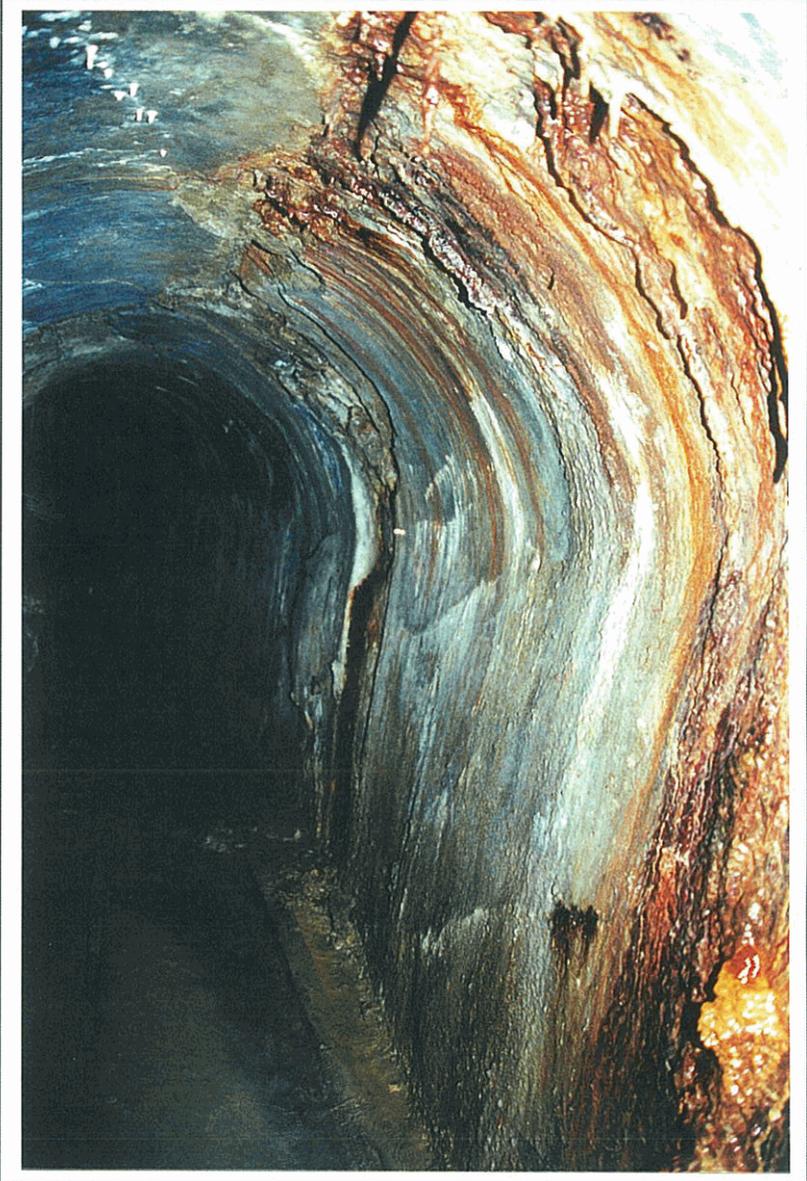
toit de la galerie fissuré avec infiltration d'eau et concrétions. Décompression des terrains et bombements en pied de parement droit
